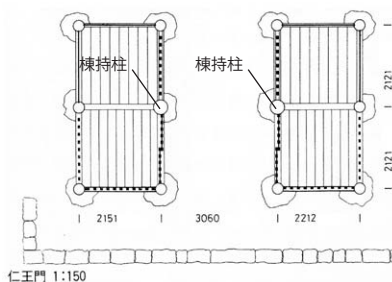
陸奥国分寺仁王門 (3 番) 平面図 1/200
